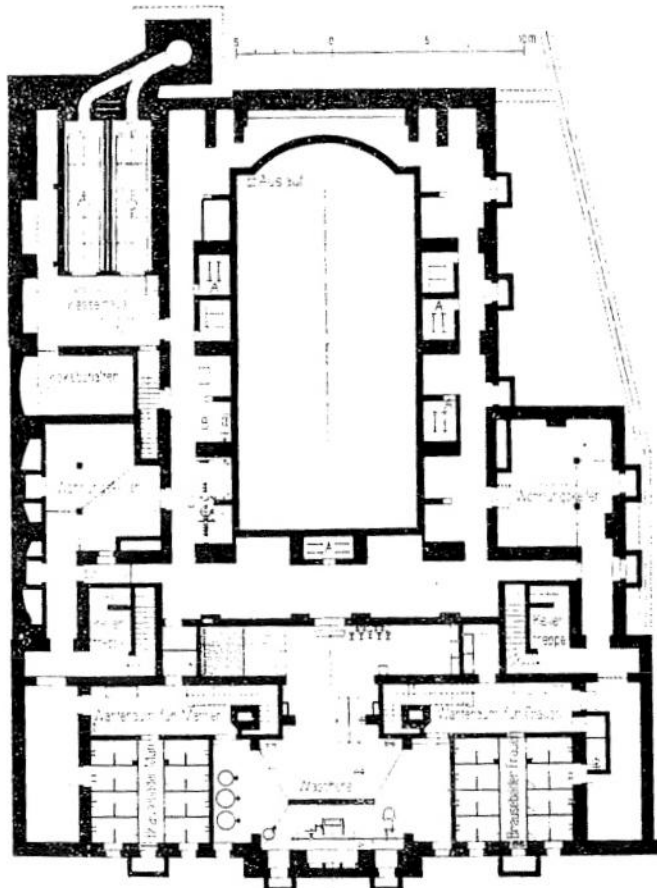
und 7. Grundrisse vom Unter- und vom Erdgeschoss. — Masstab 1:400.
